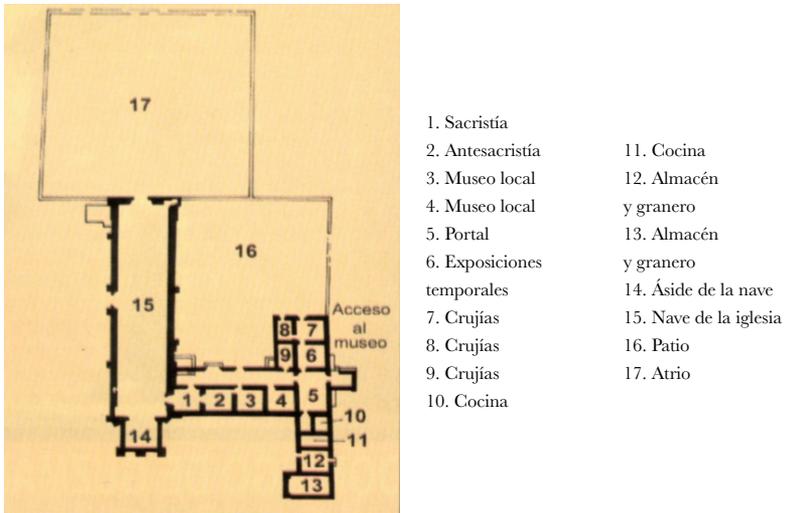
Planta arquitectónica del conjunto conventual de Oxolotán.
